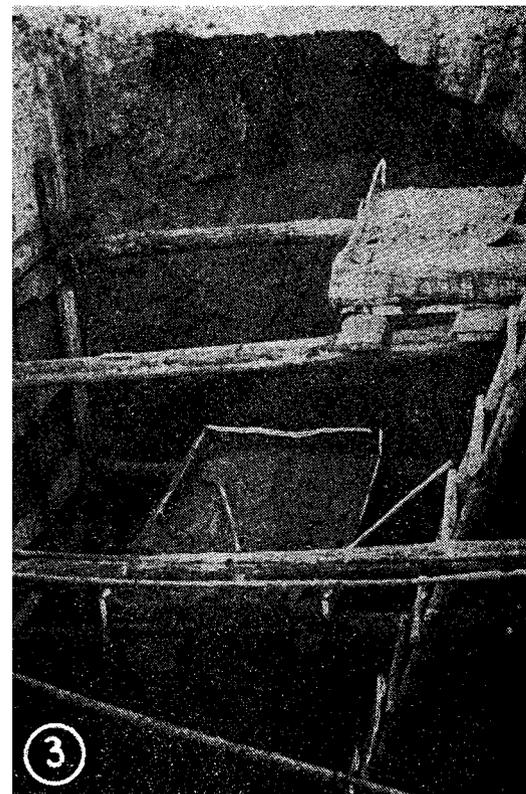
Lieu de la découverte: fosse et charpente en bois.
